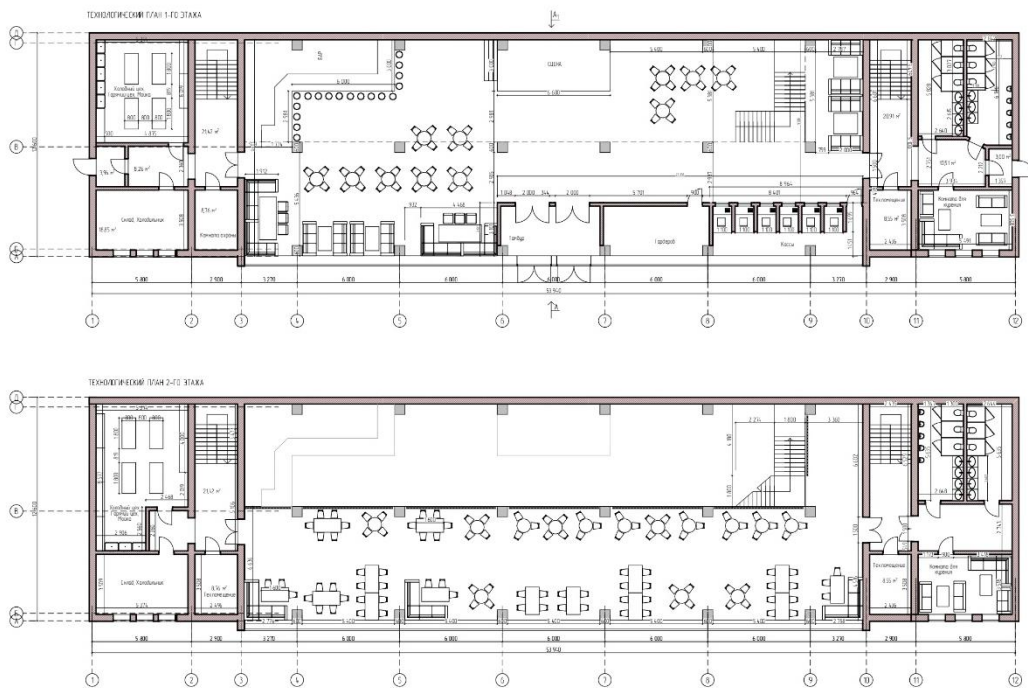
Технологический план 1-го и 2-го этажей
